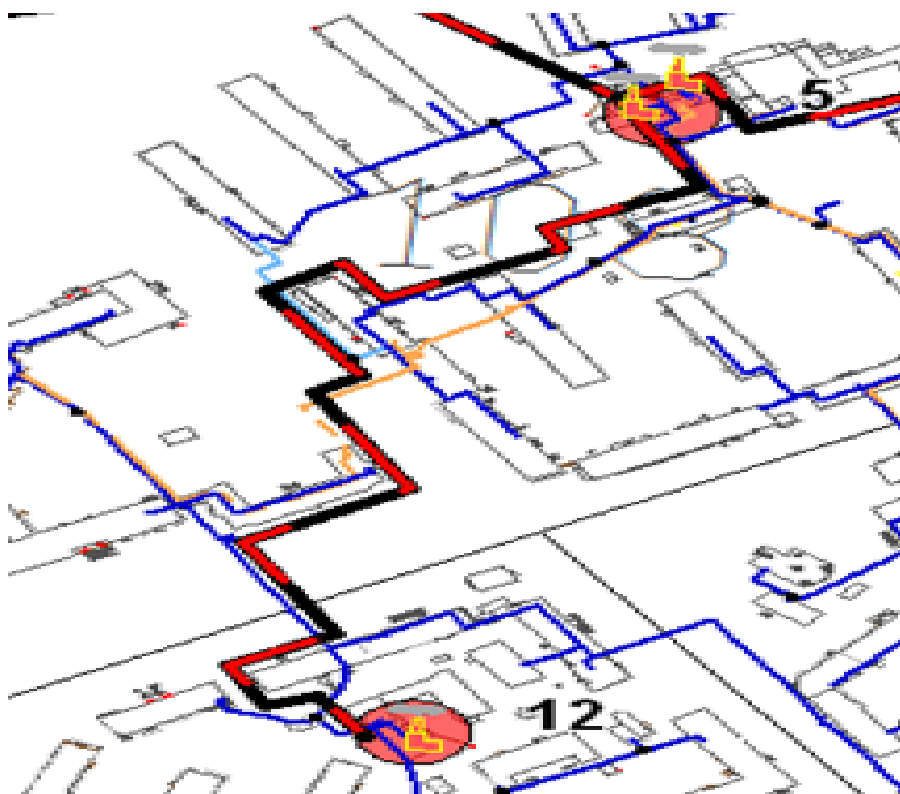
Схема прокладки трубопровода между котельными №5 и №12
